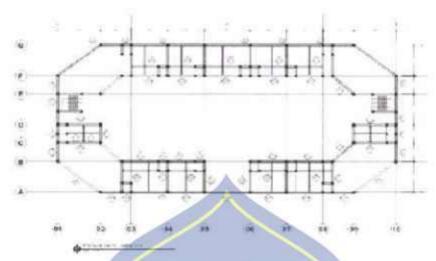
Reneant Pondasi (Sumber: Hasil Rancangan, 2021)
